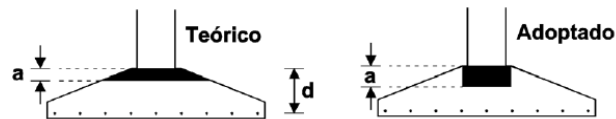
Simplificación de la sección resistente a flexión en zapatas aisladas de alzado tronco-piramidal. Fuente: “Ejemplos de Aplicación del Proyecto del Reglamento CIRSOC 201-2005”, Balat - Bissio - Ortega.
